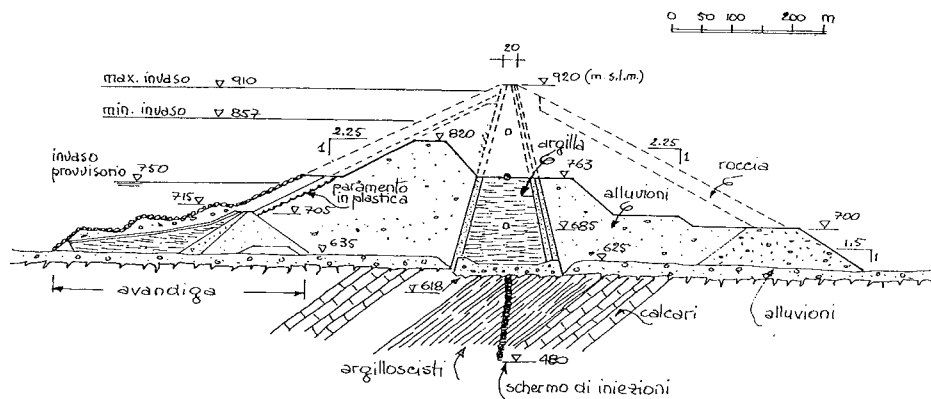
Diga di Nurek - Sezione tipo e stato di avanzamento della costruzione al febbraio 1975.
